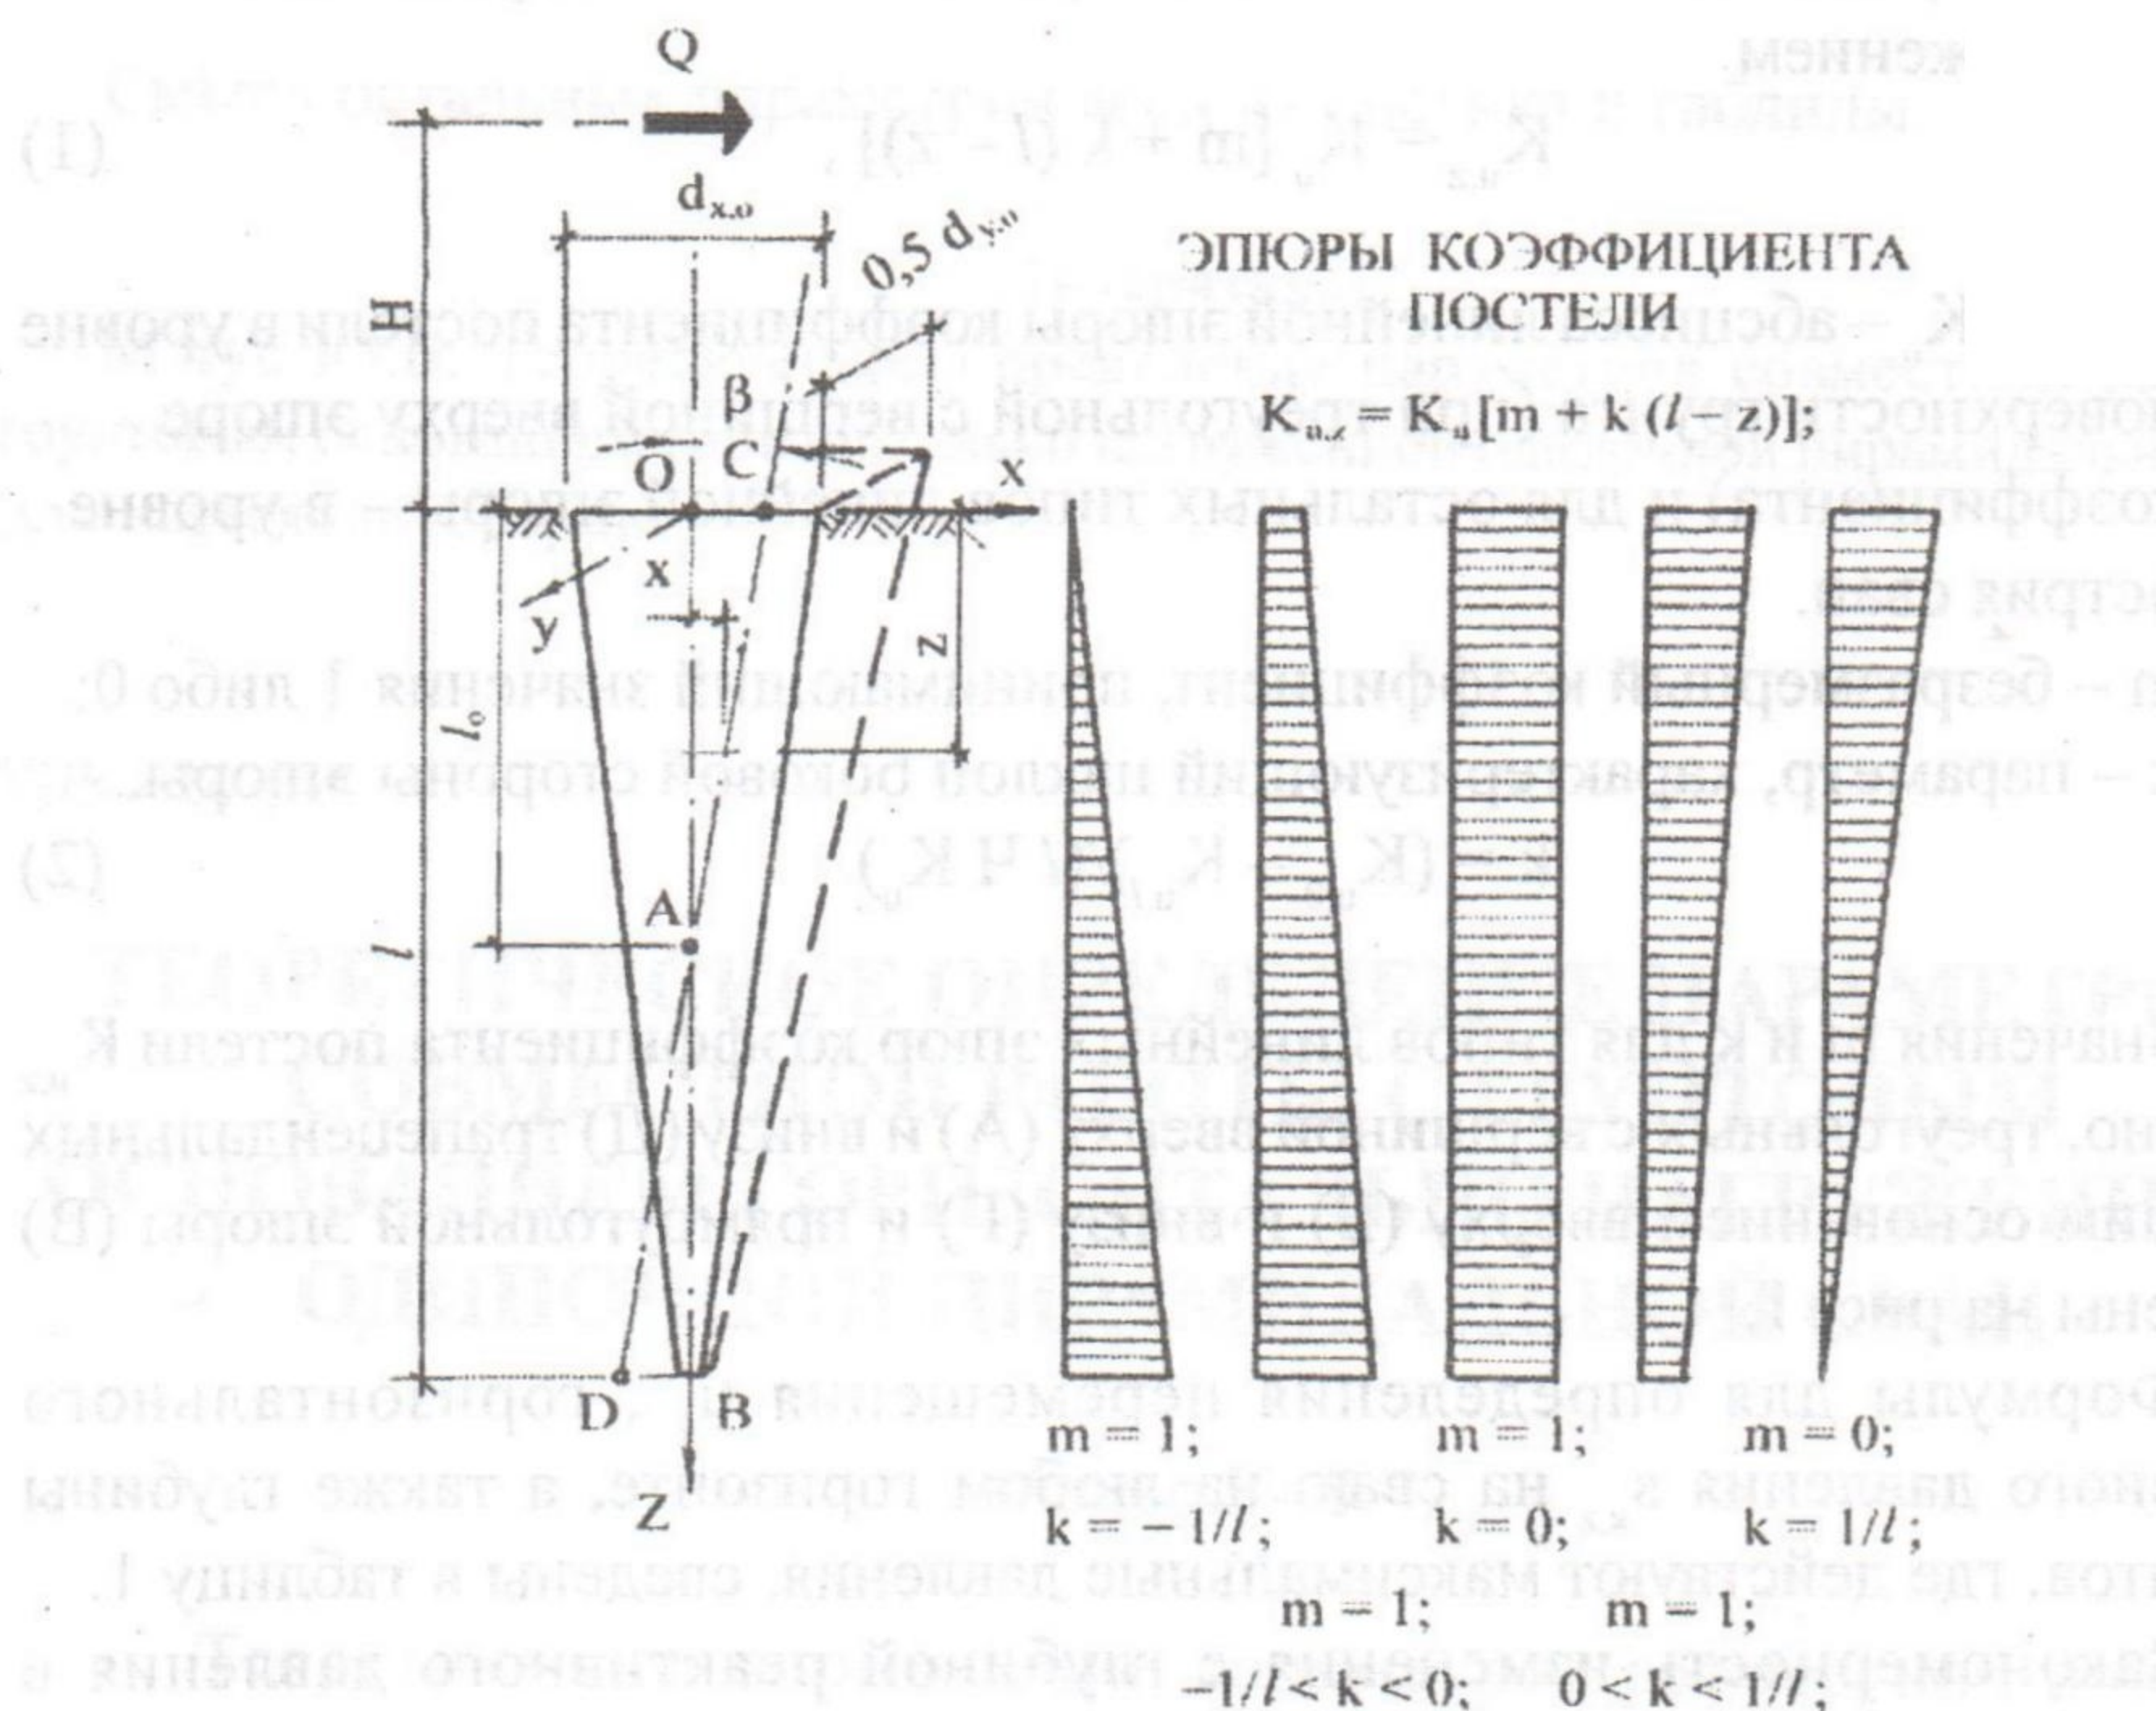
Расчетная схема горизонтально нагруженной пирамидальной сваи.
